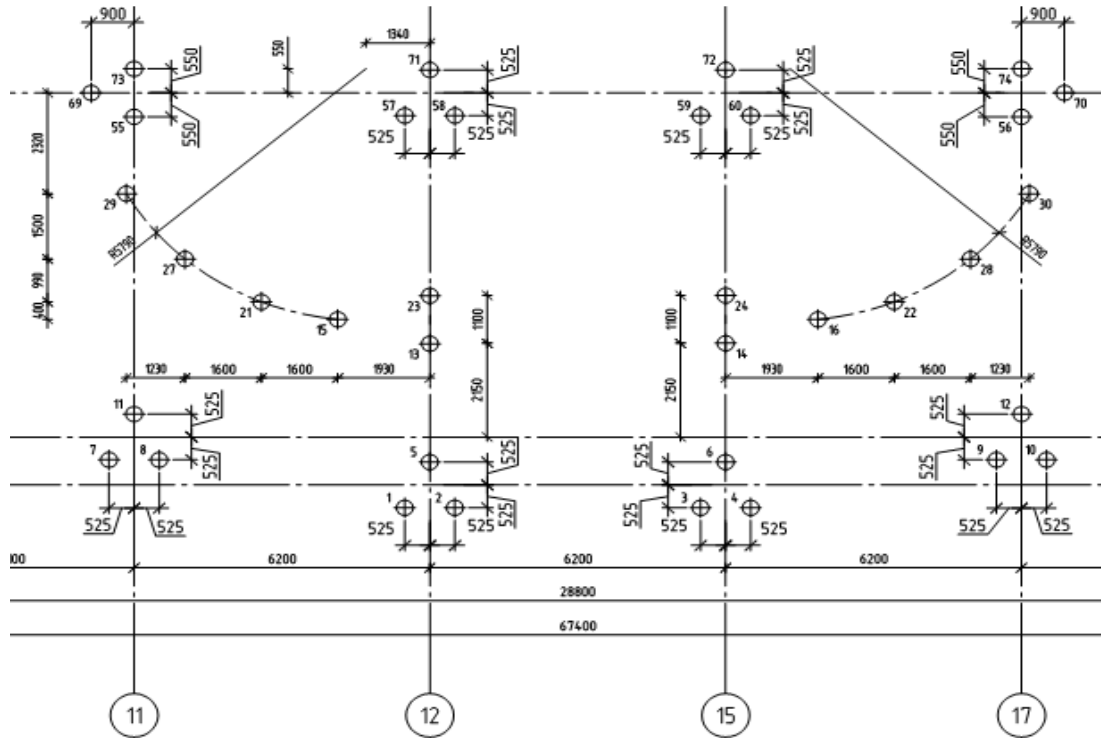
Фрагмент плану пального поля будівлі із 728 палів
